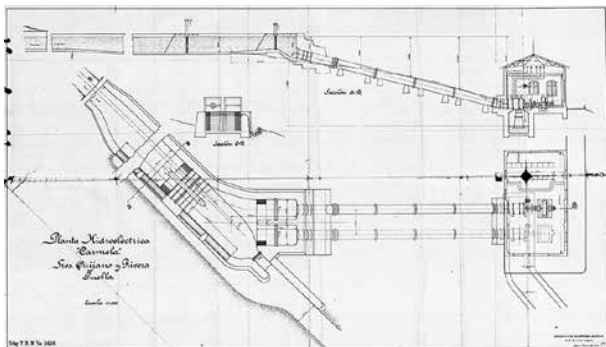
Planta y corte de la planta hidroeléctrica Carmela, 1912. AHA, AS, c. 4211, exp. 56704, f. 143.
